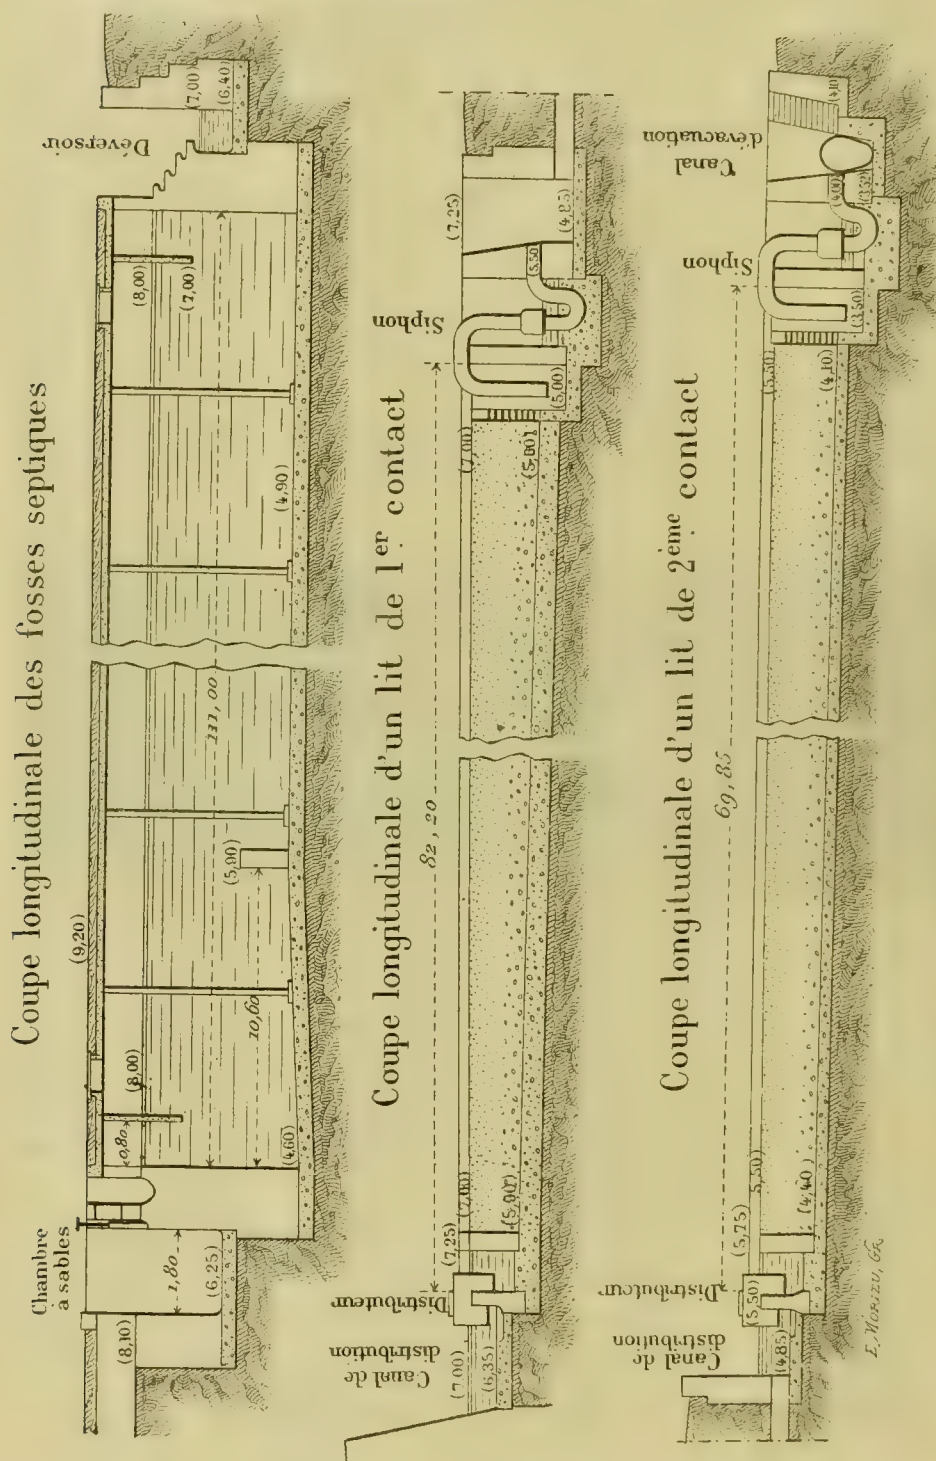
Station d'épuration des eaux d'égout de Toulon, à Lagoubran.
